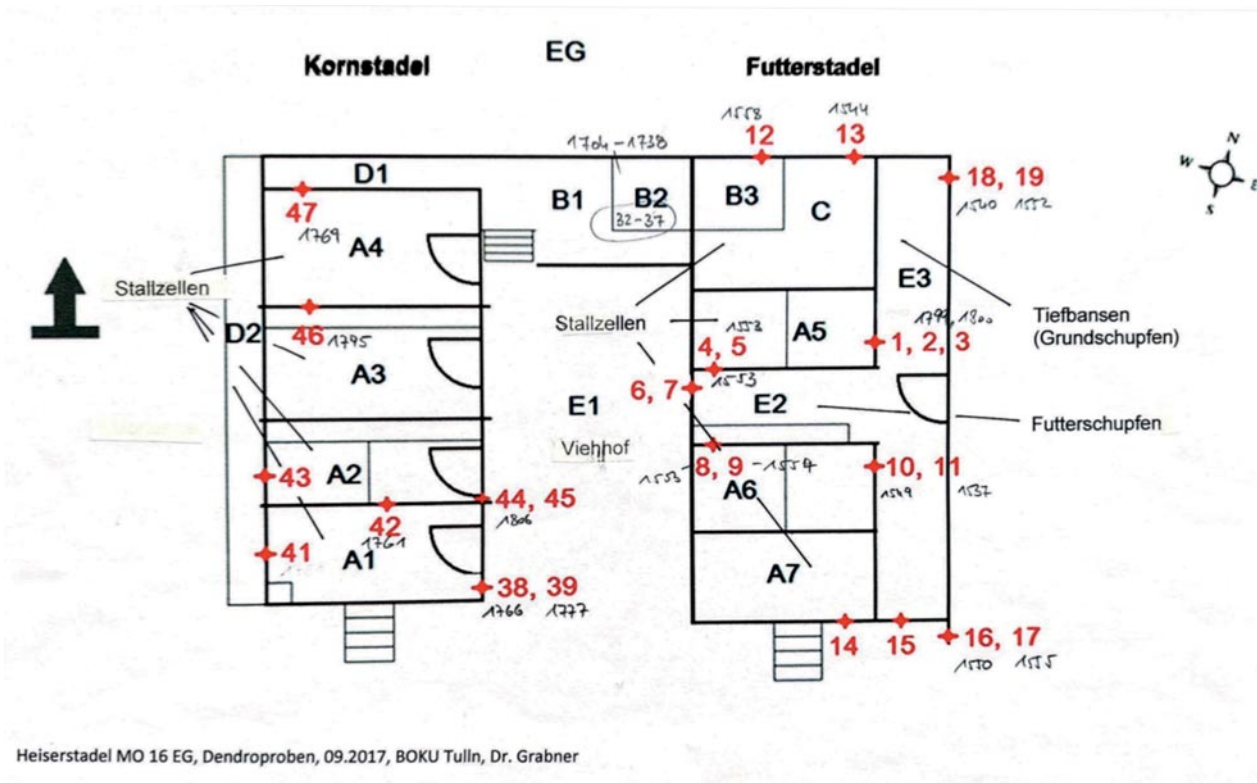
Heiserstadel – Grundriss EG, Skizze: H. Schinnerl und M. Grabner
